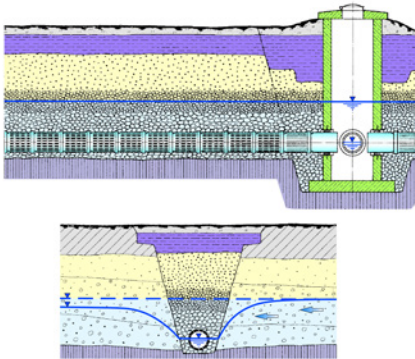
Schematische Darstellung einer Sickerrohrleitung mit Schacht
